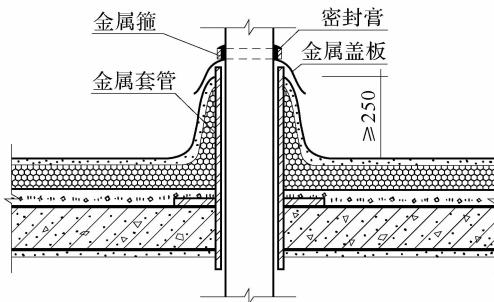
喷涂硬泡聚氨酯屋面伸出屋面管道防水构造
